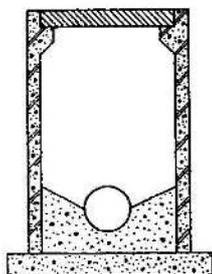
鉄筋コンクリート製柵の例（一部現場施工、既製ブロック使用）
